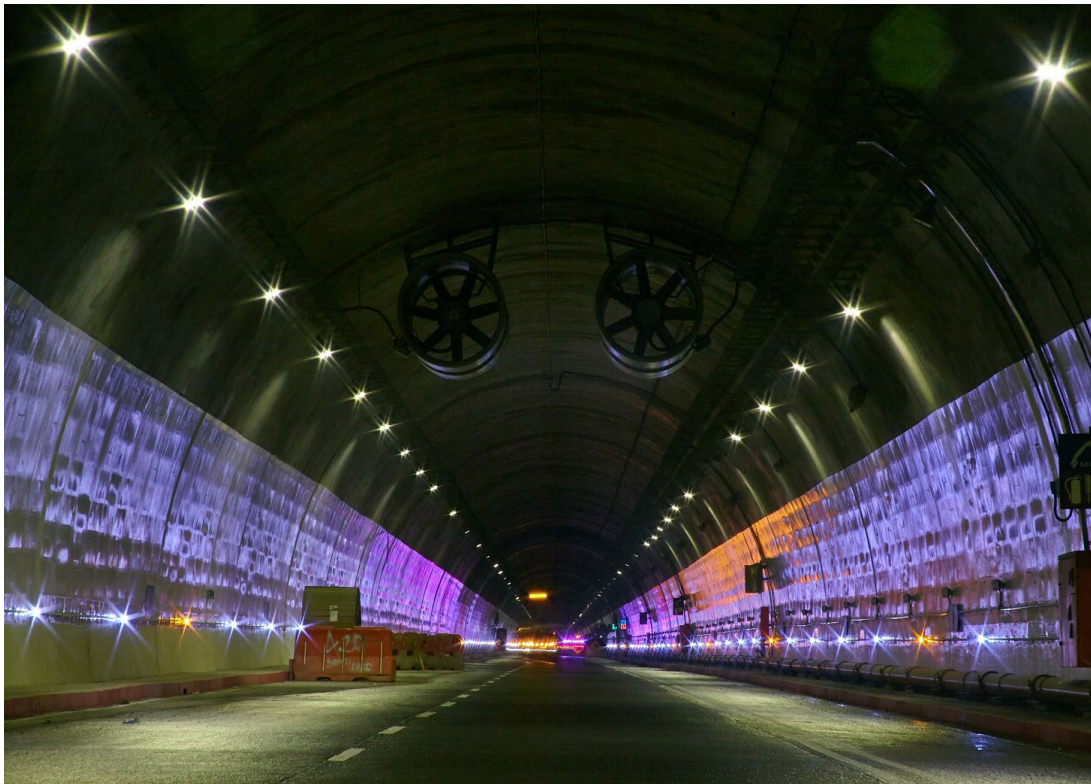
Sistema de ventilación, Túnel de La Línea
